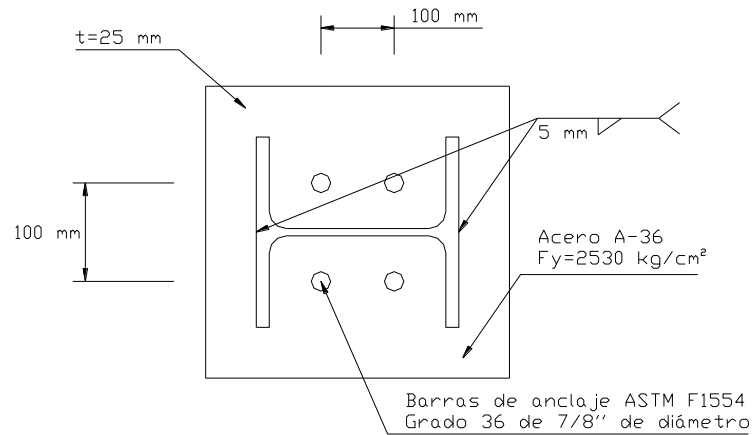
Detallado en Planta del Ejemplo 5.
